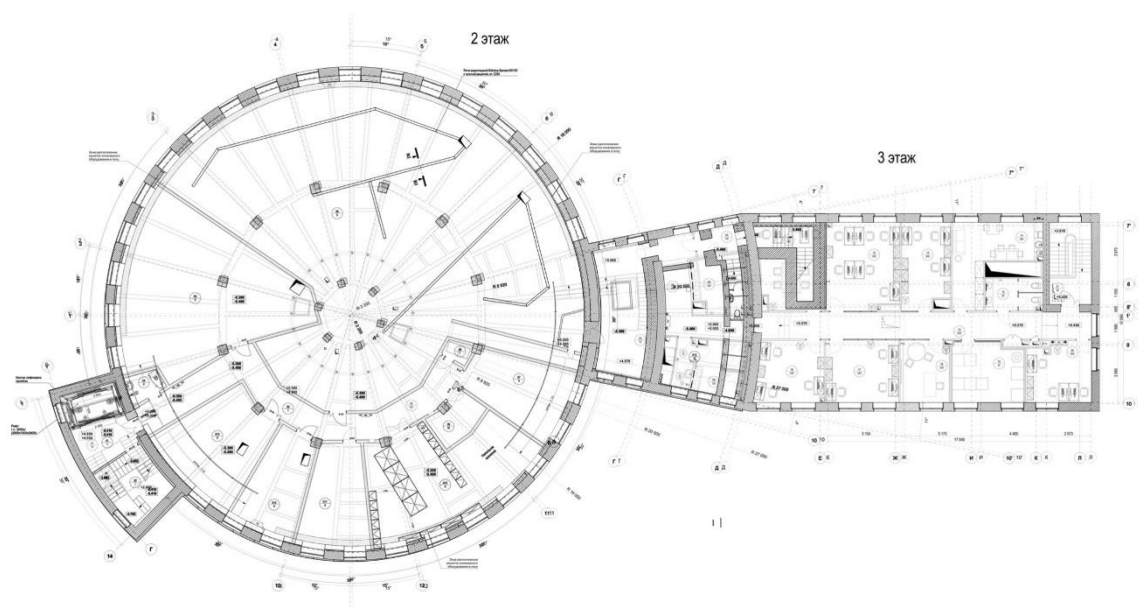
План 2-го этажа Хлебозавода №5 после реконструкции
